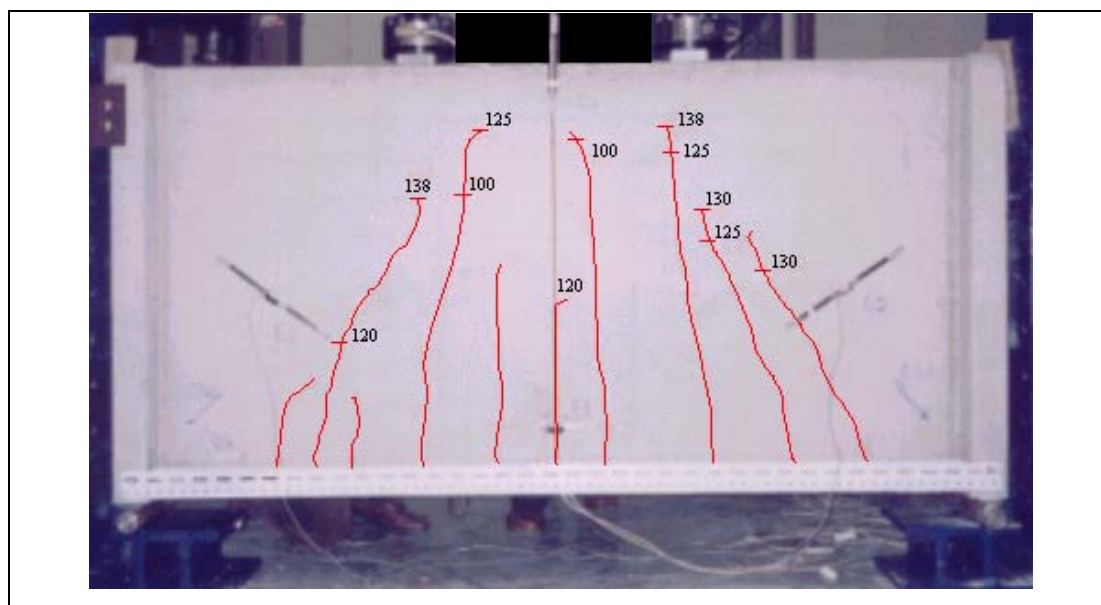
Panorama de fissuração da viga-parede antes da paralisação do ensaio
